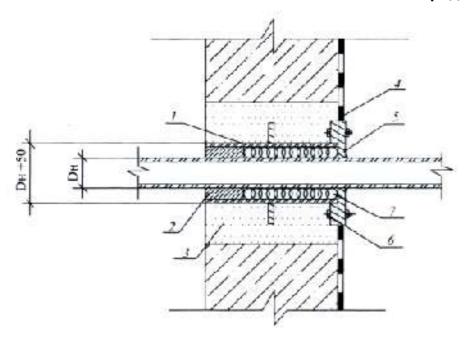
Конструктивное решение по устройству гидроизоляции фундаментов из ФБС-блоков при новом строительстве
